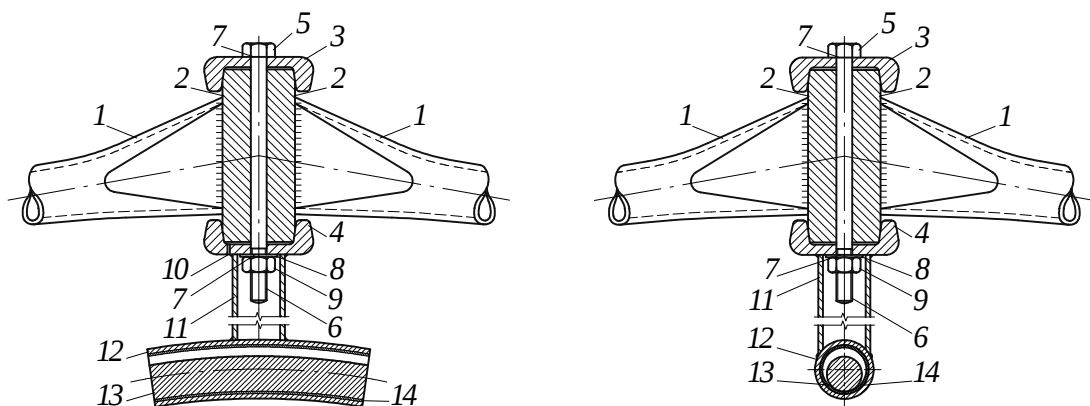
Вузол з'єднання стержнів серединної поверхні одношарового циліндричного сітчастого покриття з елементами підкріплення: 1 – трубчасті стержні; 2 – клиновидні наконечники; 3 – верхній вузловий диск; 4 – нижній вузловий диск; 5 – стяжний болт; 6 – нарізна різьба; 7 – отвори; 8 – підкладна шайба; 9 – гайка; 10 – отвір у вигляді крапельника; 11 – циліндрична оболонка; 12 – криволінійний трубчастий стержень; 13 – підпружна діафрагма; 14 – підкладковий матеріал
